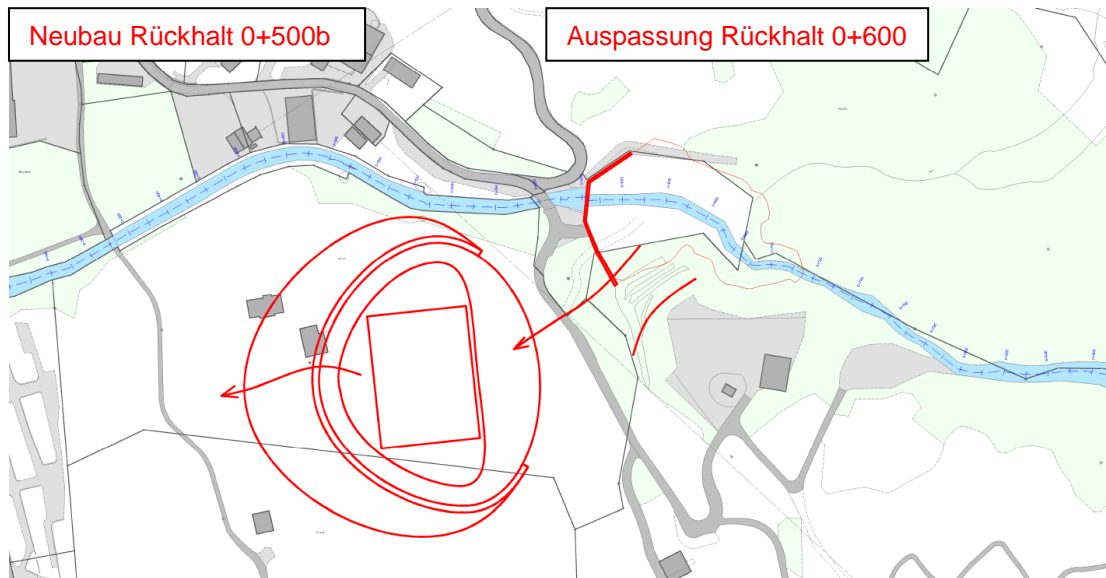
Variante 11, Umbau des bestehenden Rückhalts 0+600, Bau einer Überleitung, Neubau Rückhalt 0+500b
